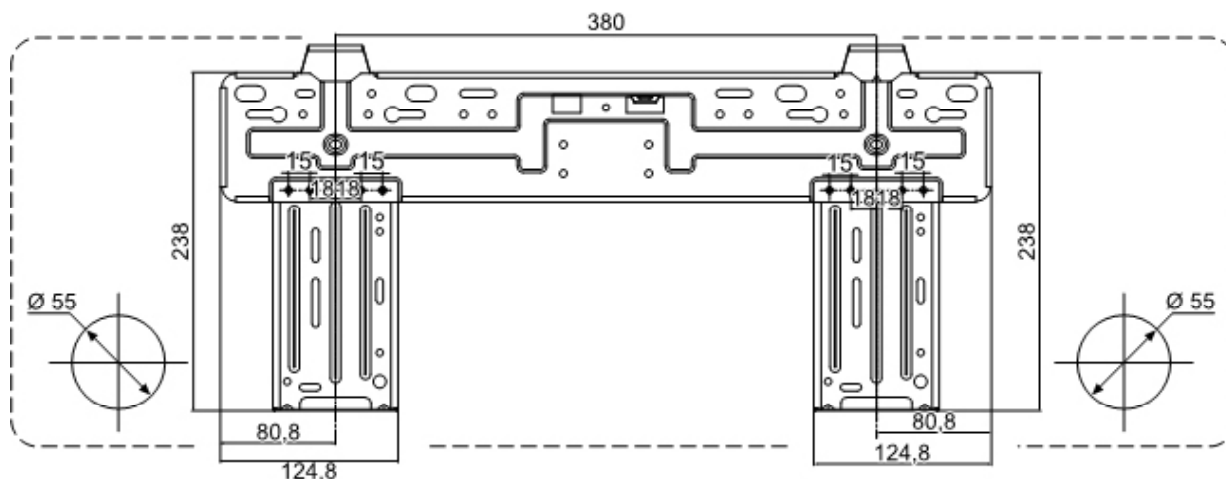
Placa de montaje para 3-025 WMNI y 3-035 WMNI.
